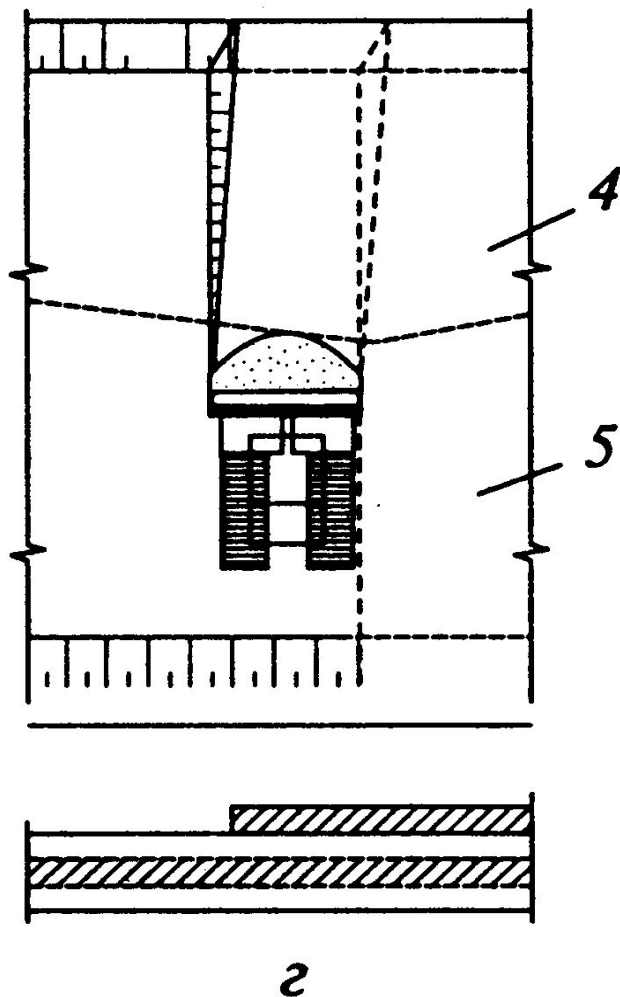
(Окончание). Схема резания и перемещения грунта бульдозером: 4 – насыпь; 5 – выемка
